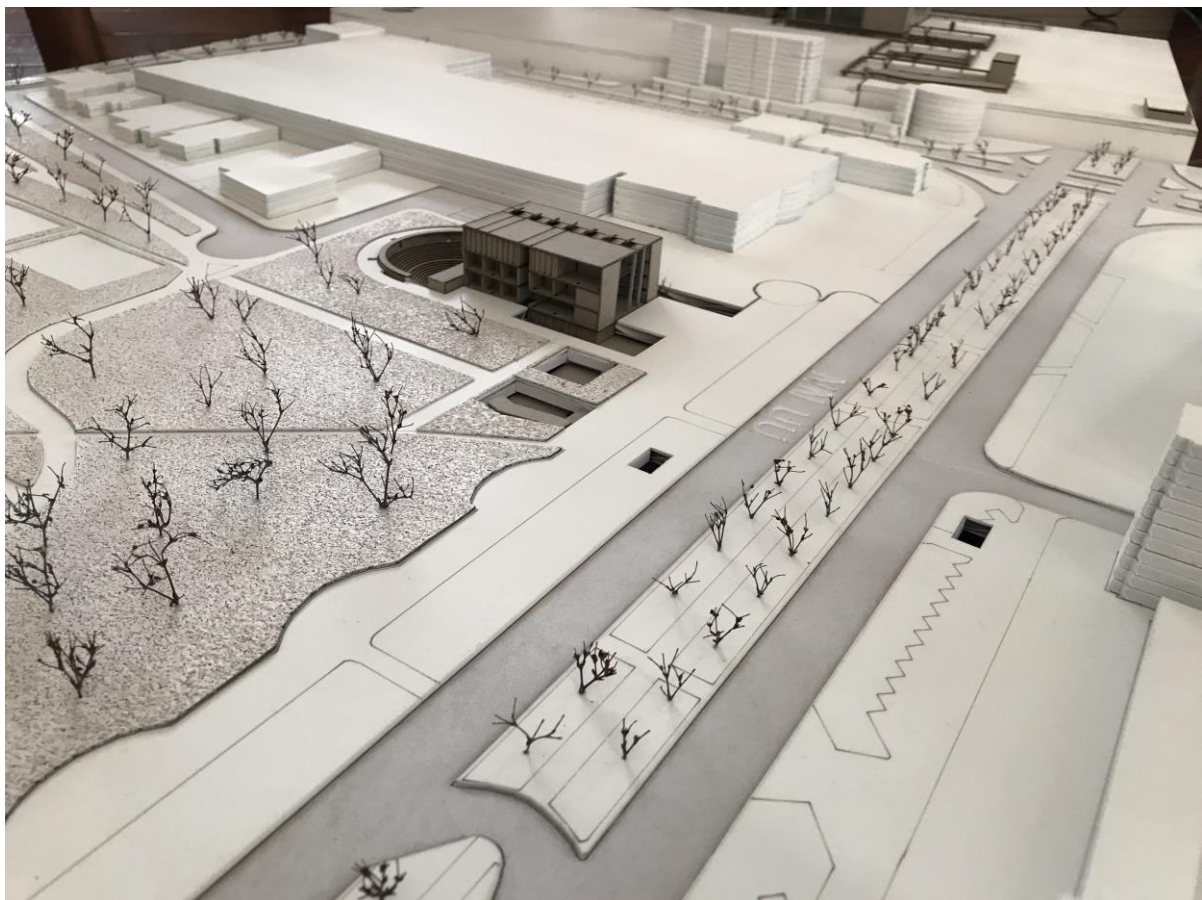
Fotografía 2 Maqueta final 1:500. Proyecto dentro del contexto. Elaboración propia.
